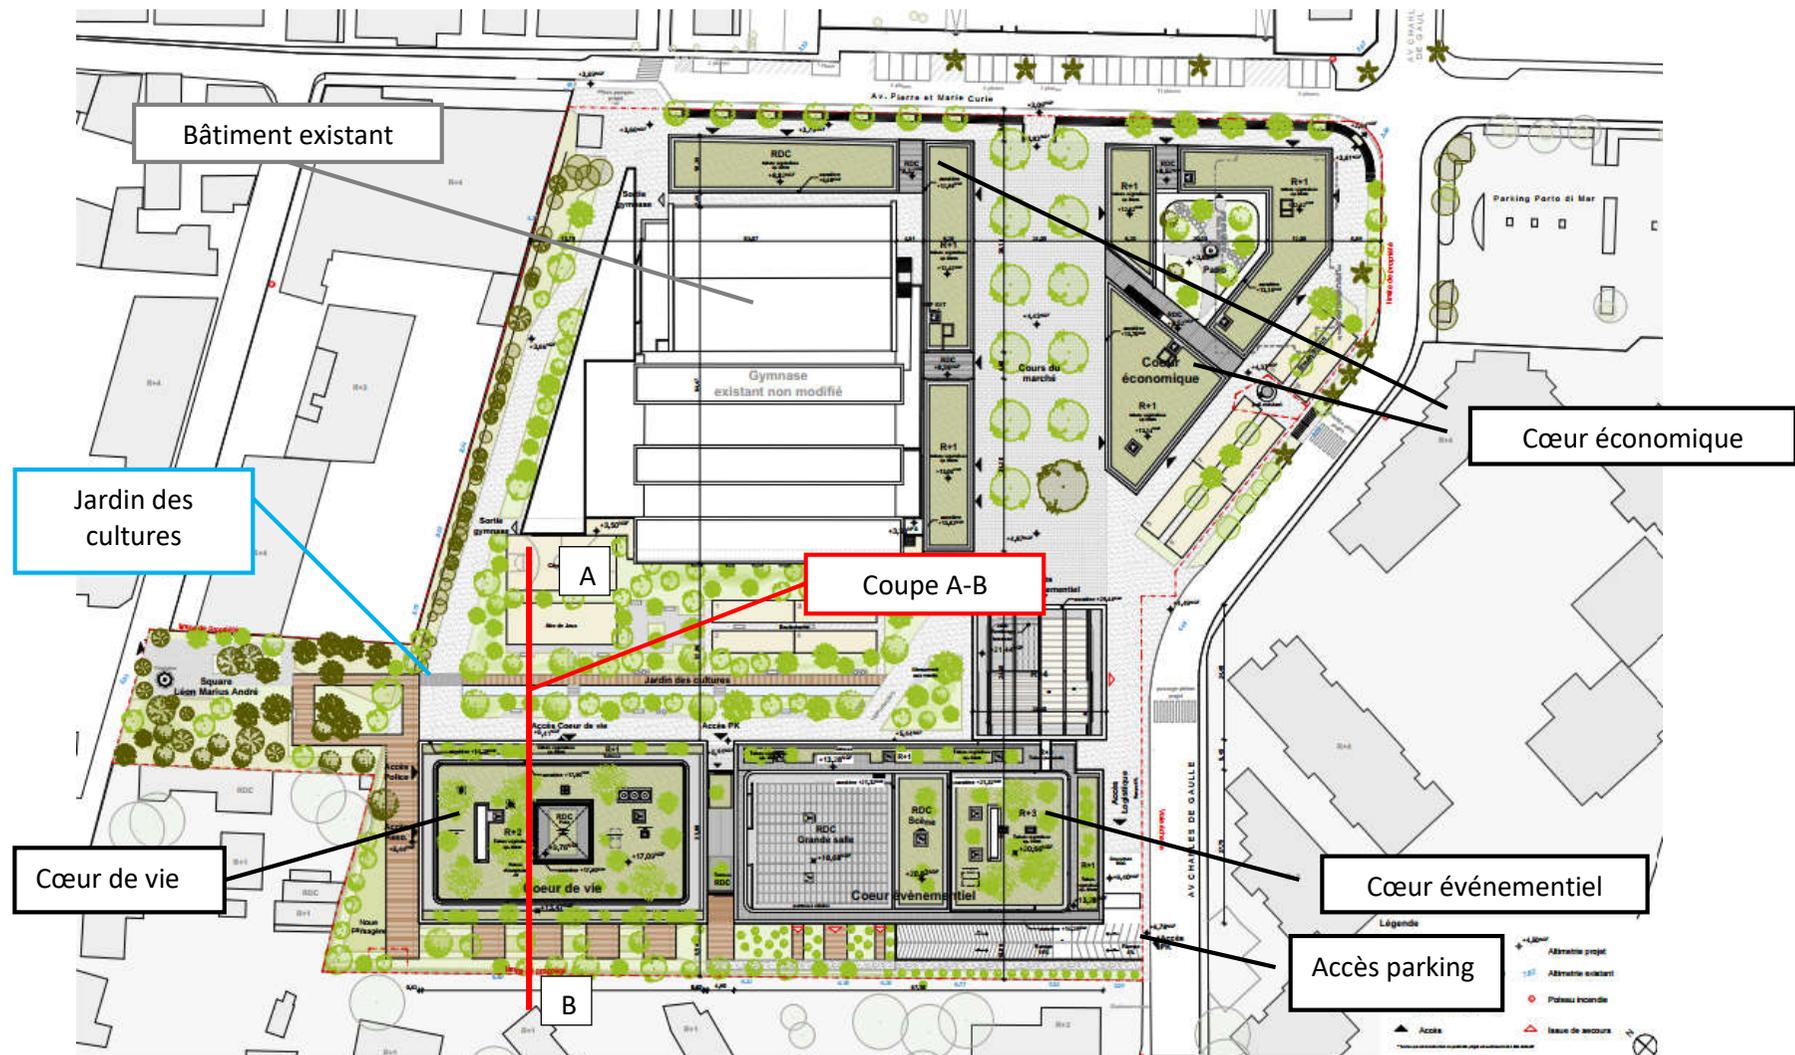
Plan de masse du projet (Source : Atelier du Pont, 2024)
